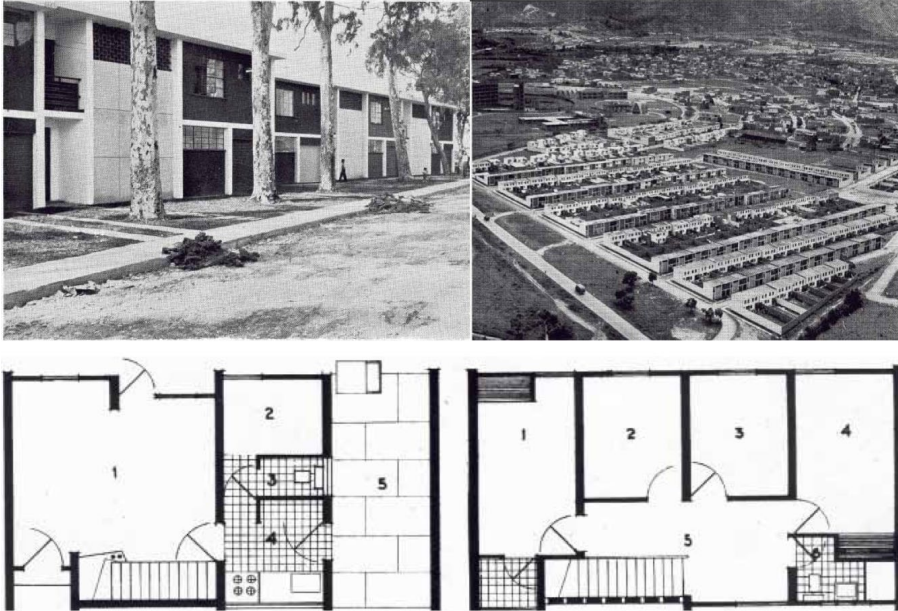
Barrio "Los Alcázares". Bogotá, Instituto de Crédito Territorial: plan general, fachada y planta típica de las viviendas
